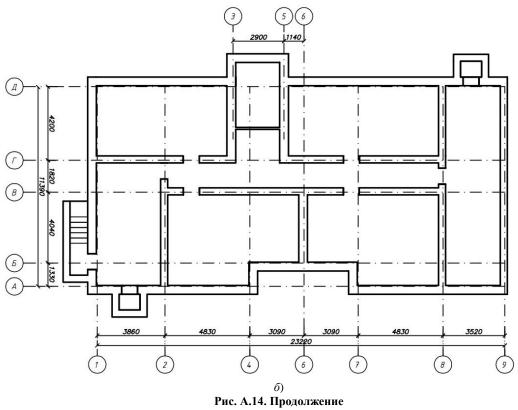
Вариант 13: a — план типового этажа; δ — план подвала
